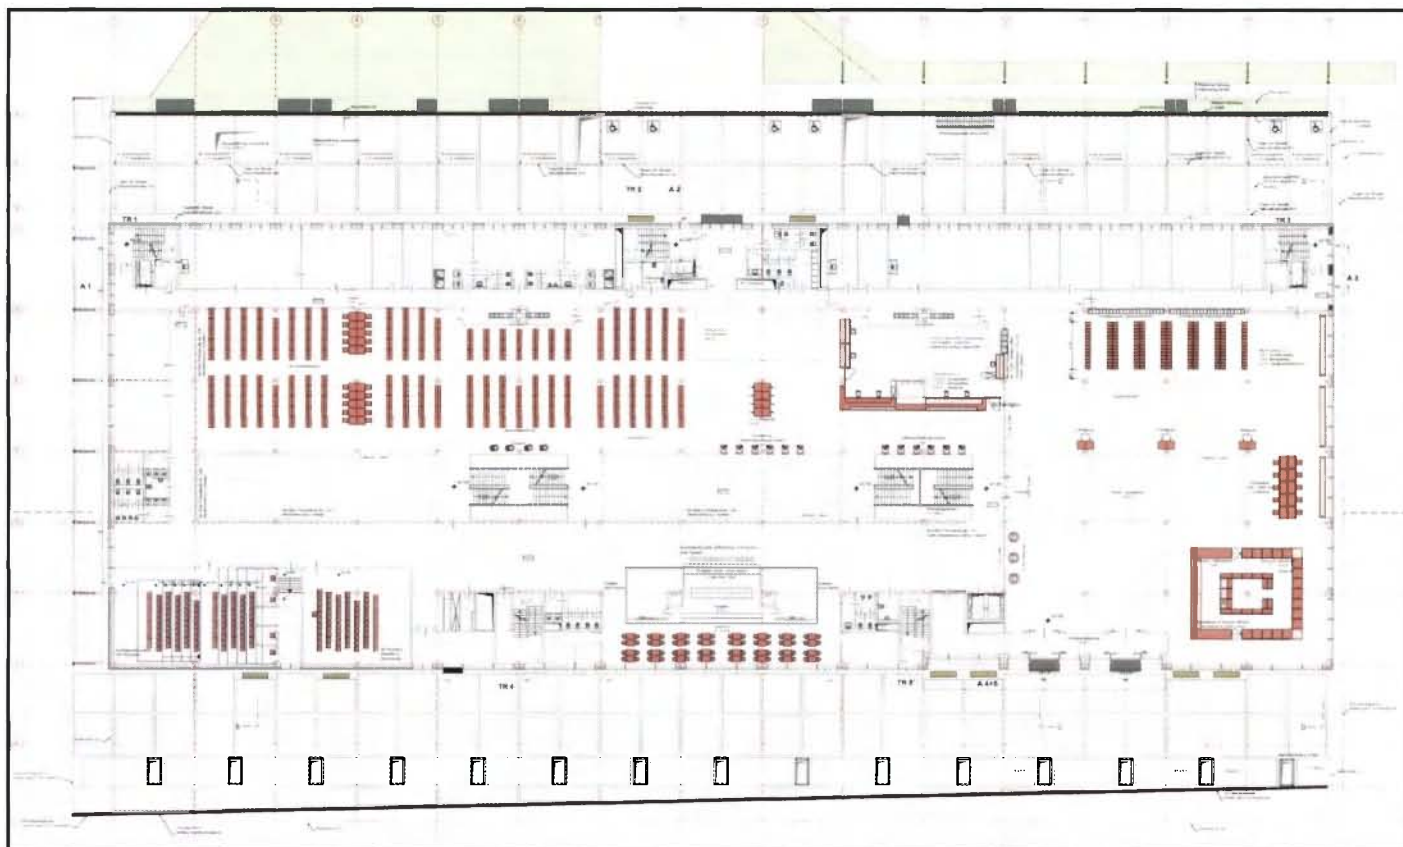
Grundriss Erdgeschoss (mit Möblierung im Freihandbereich), Prof. Walter A. Noebel
